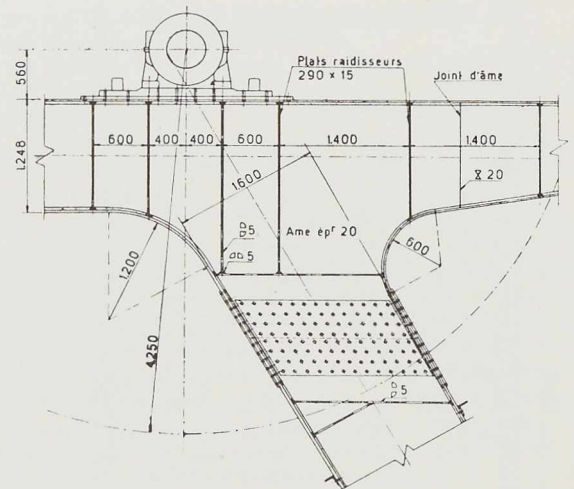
Dispositif de liaison du support avec le poussard secondaire. Détail B du plan de la figure 22.
